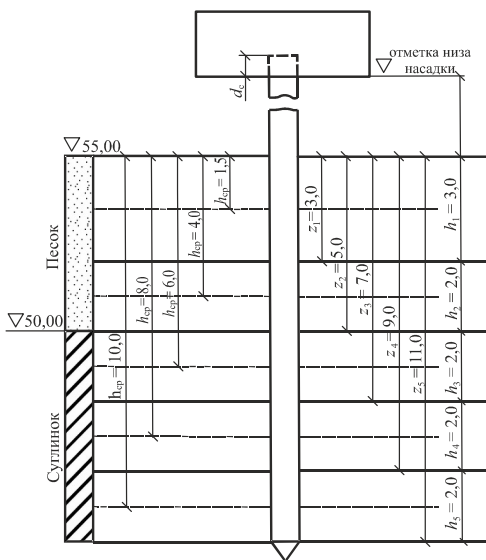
Примерная расчетная схема свайного фундамента для устоев на пойме реки
